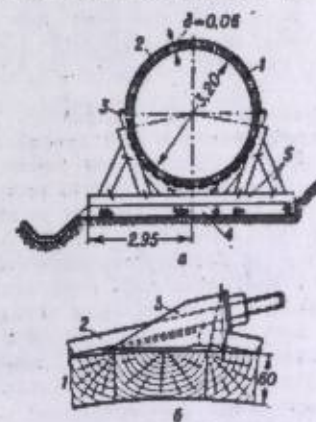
Деревянный трубопровод: а — поперечный разрез, размеры в м; б — детали бандажа и клепок, размеры в см; 1 — клепок; 2 — бандаж; 3 — бандаж; 4 — подготавливаемая щель; 5 — опорные элементы трубопровода.
